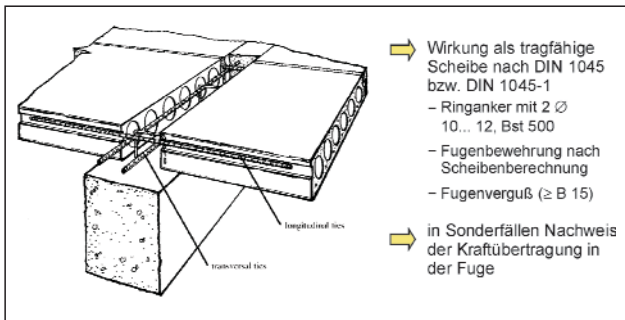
Bemessung und konstruktive Durchbildung der Deckenscheibe
